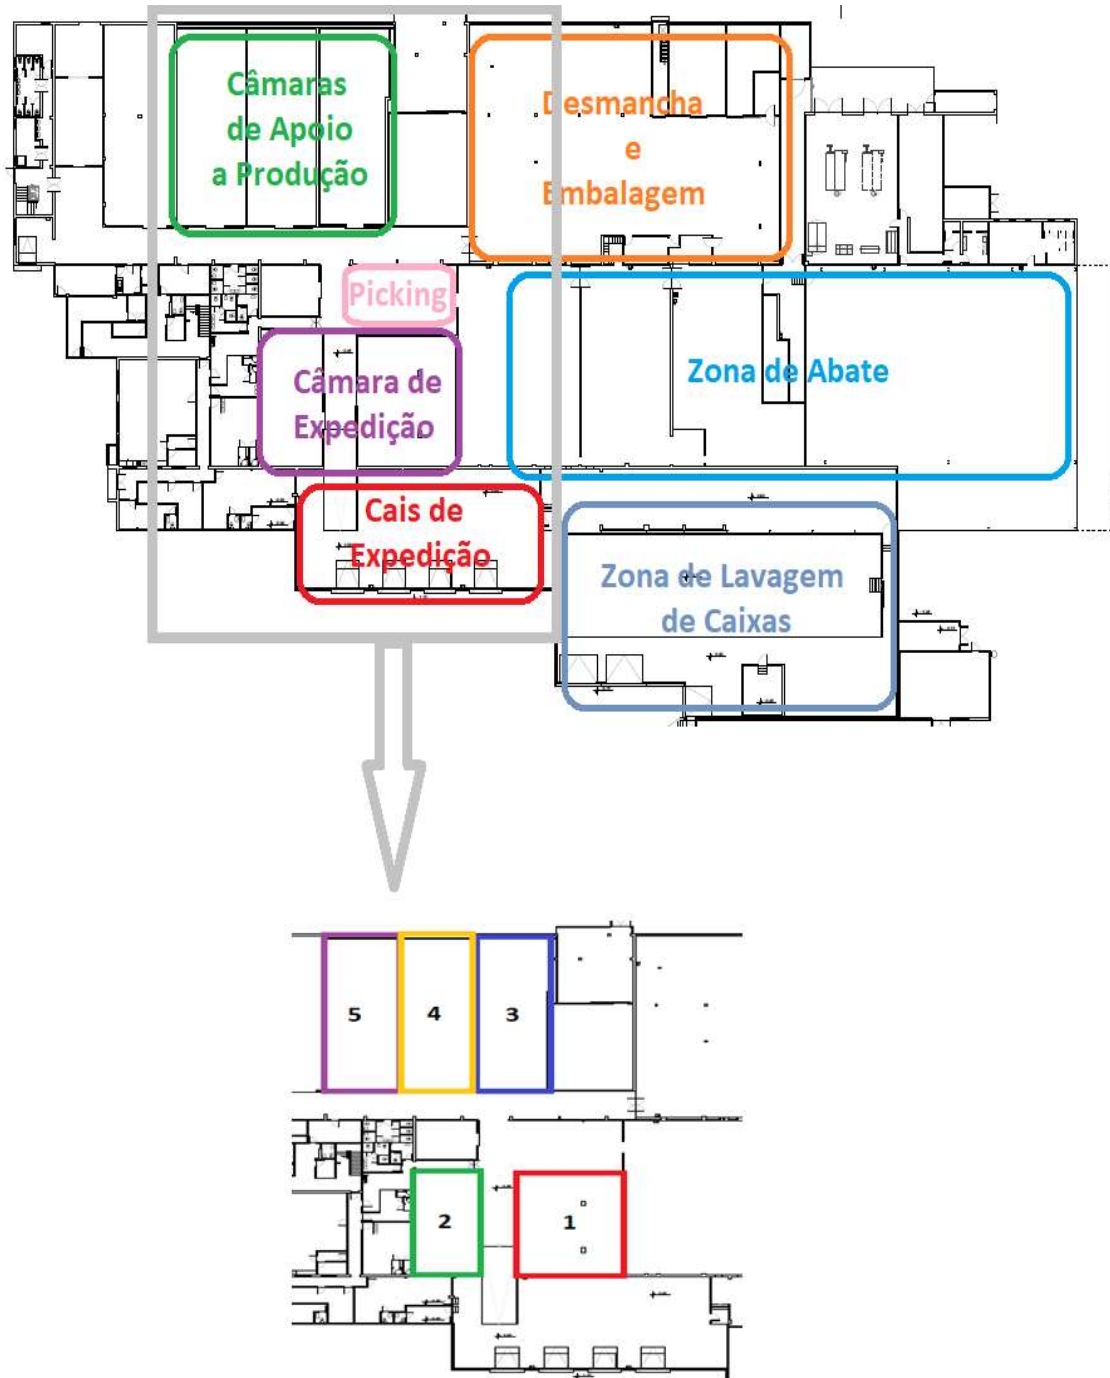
Planta Geral da Unidade e pormenor das câmaras frigoríficas
